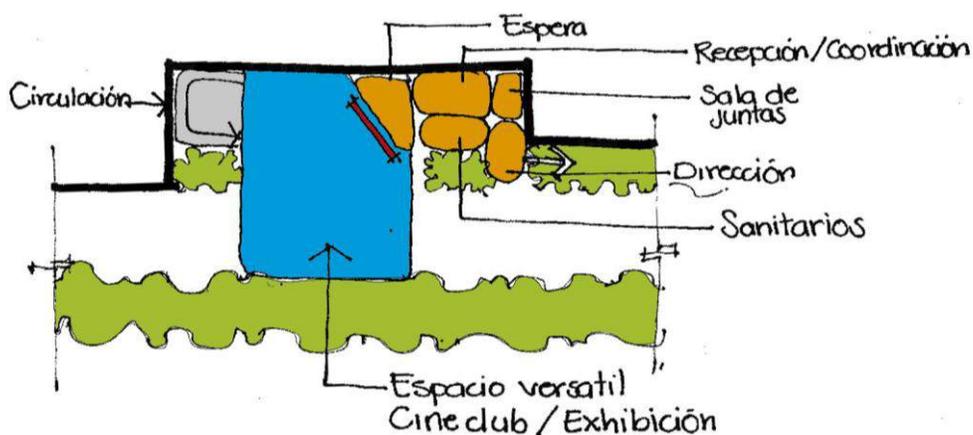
Zonificación de áreas Esquema 3. Planta baja.
